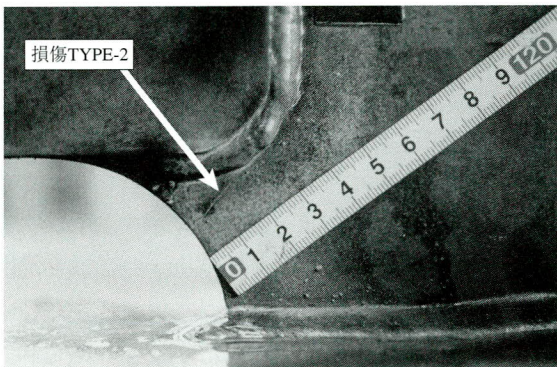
TYPE-2損傷部 (図-8 ② 301万回時)
